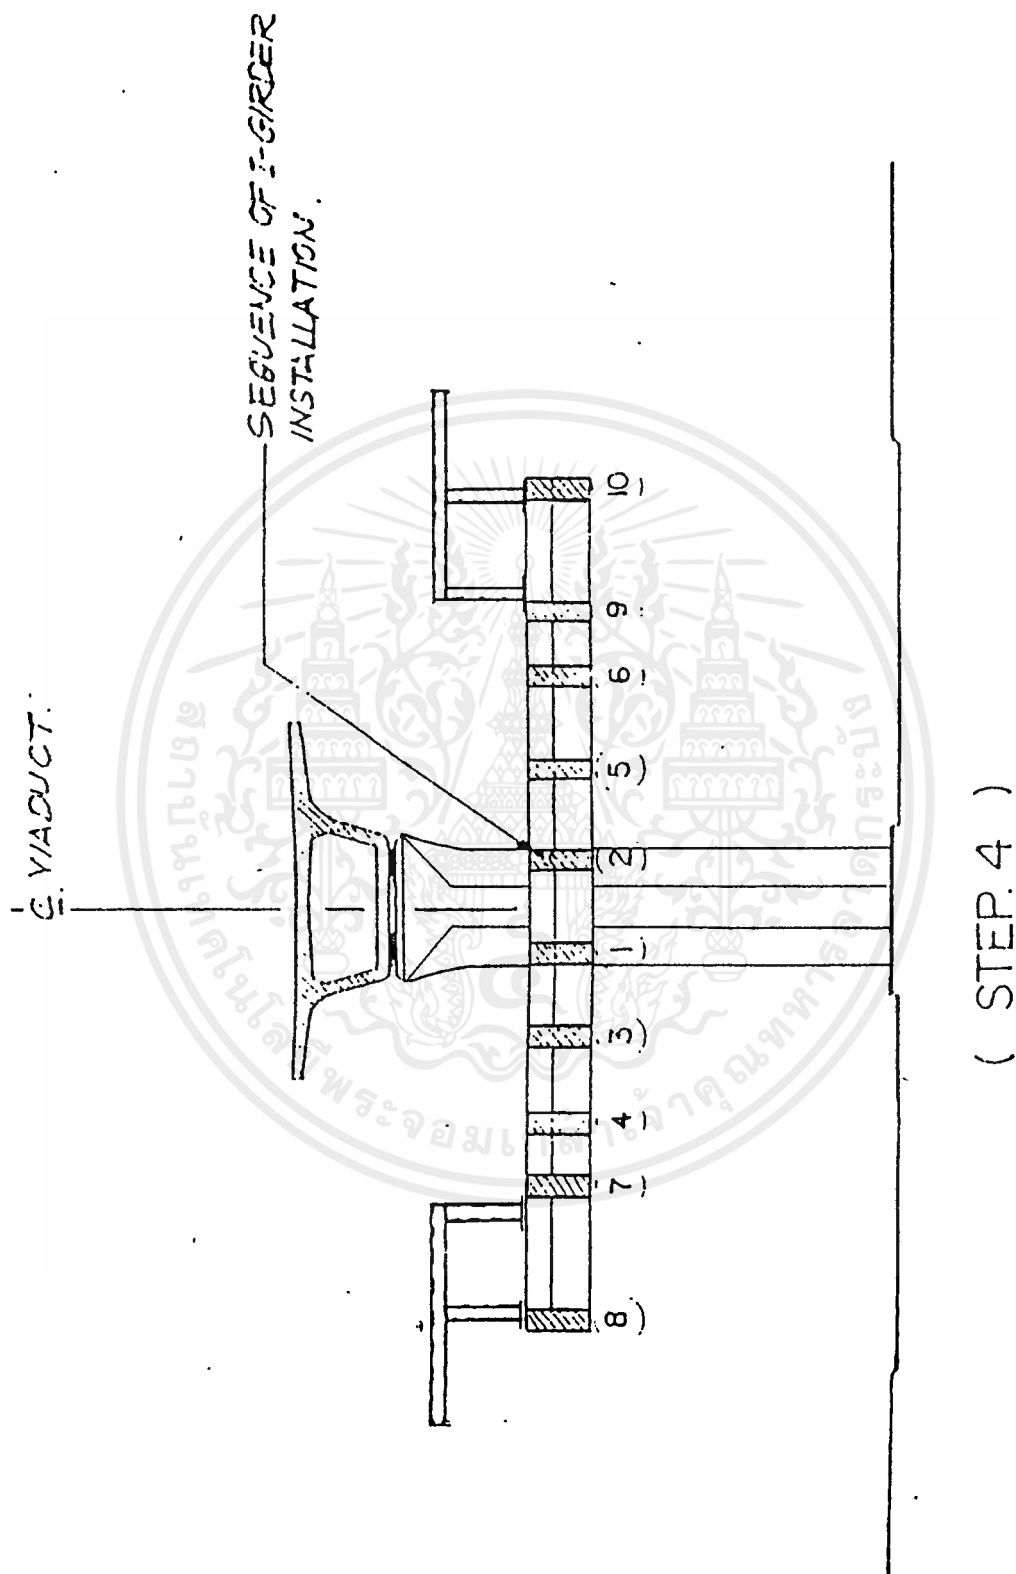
ยก I-Girder ขึ้นโดยใช้ Lifting Jack และ เลื่อนไปยังตำแหน่งที่จะติดตั้งโดย Sliding Jack
